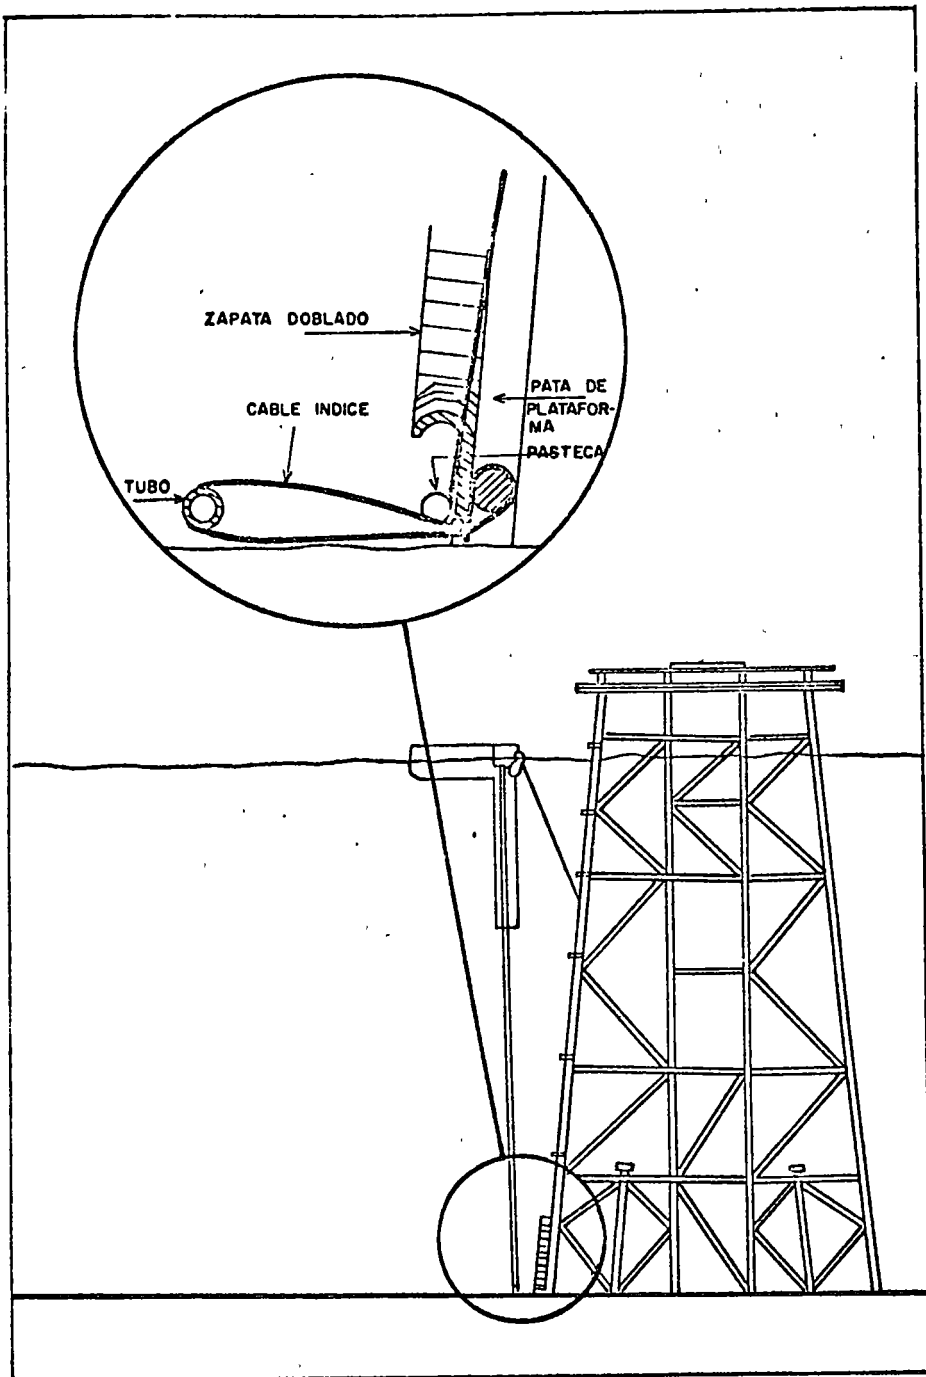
Dispositivo emergencia para colocar la tubería bajo la Zapata
